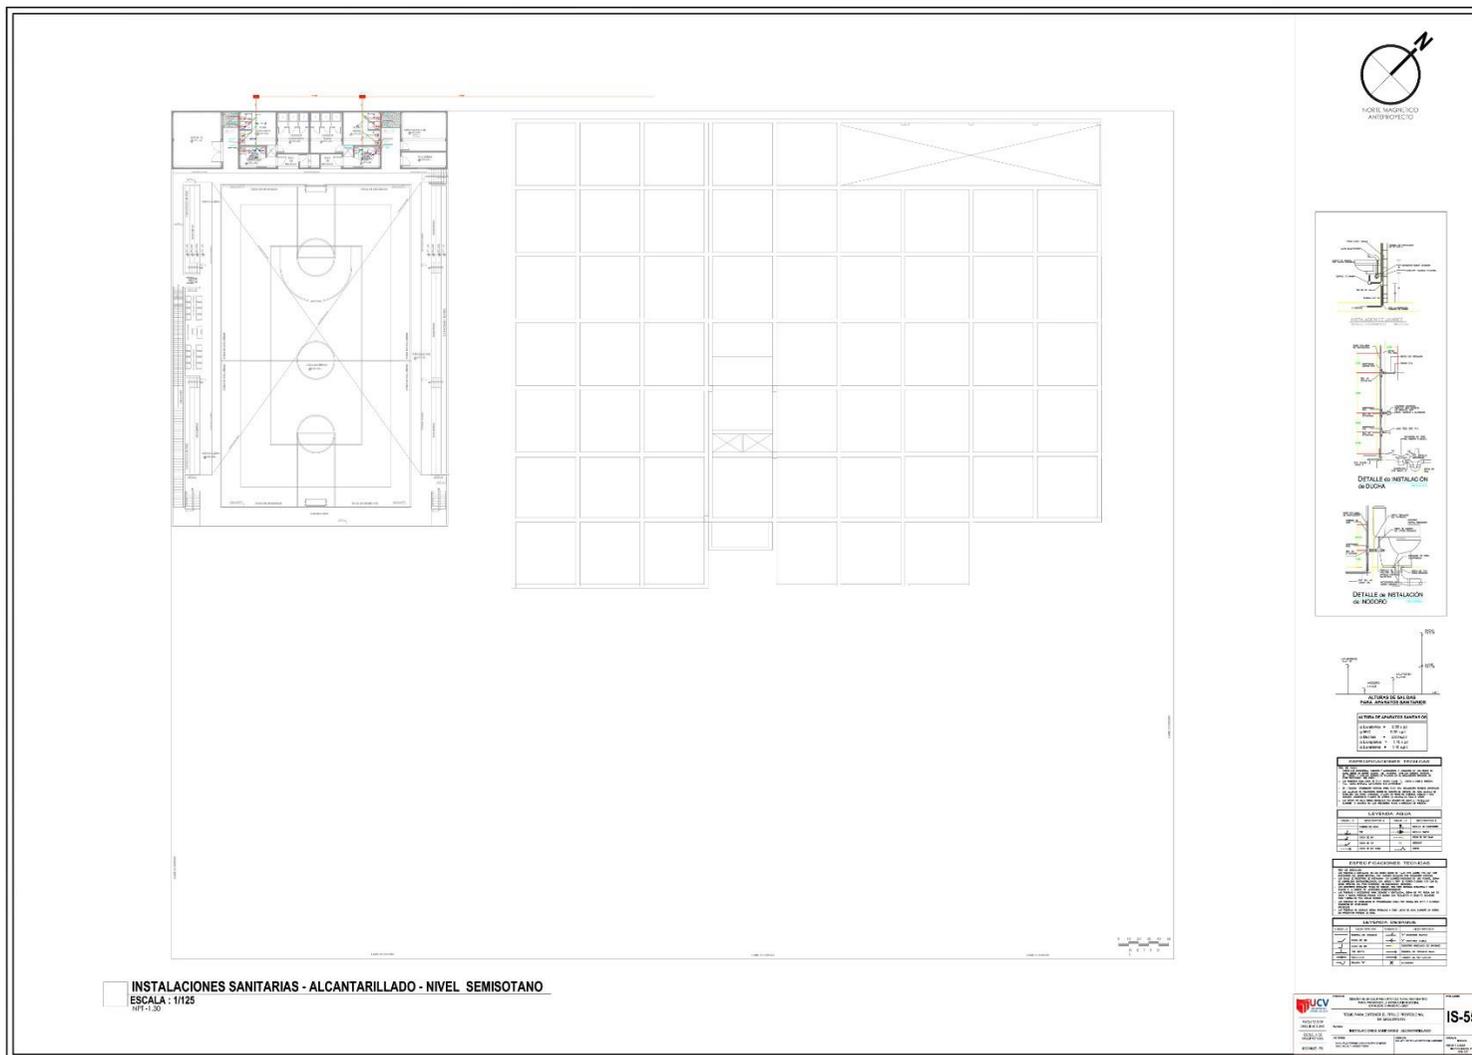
Plano de Instalaciones Sanitarias - Alcantarilla Nivel Semi Sótano
